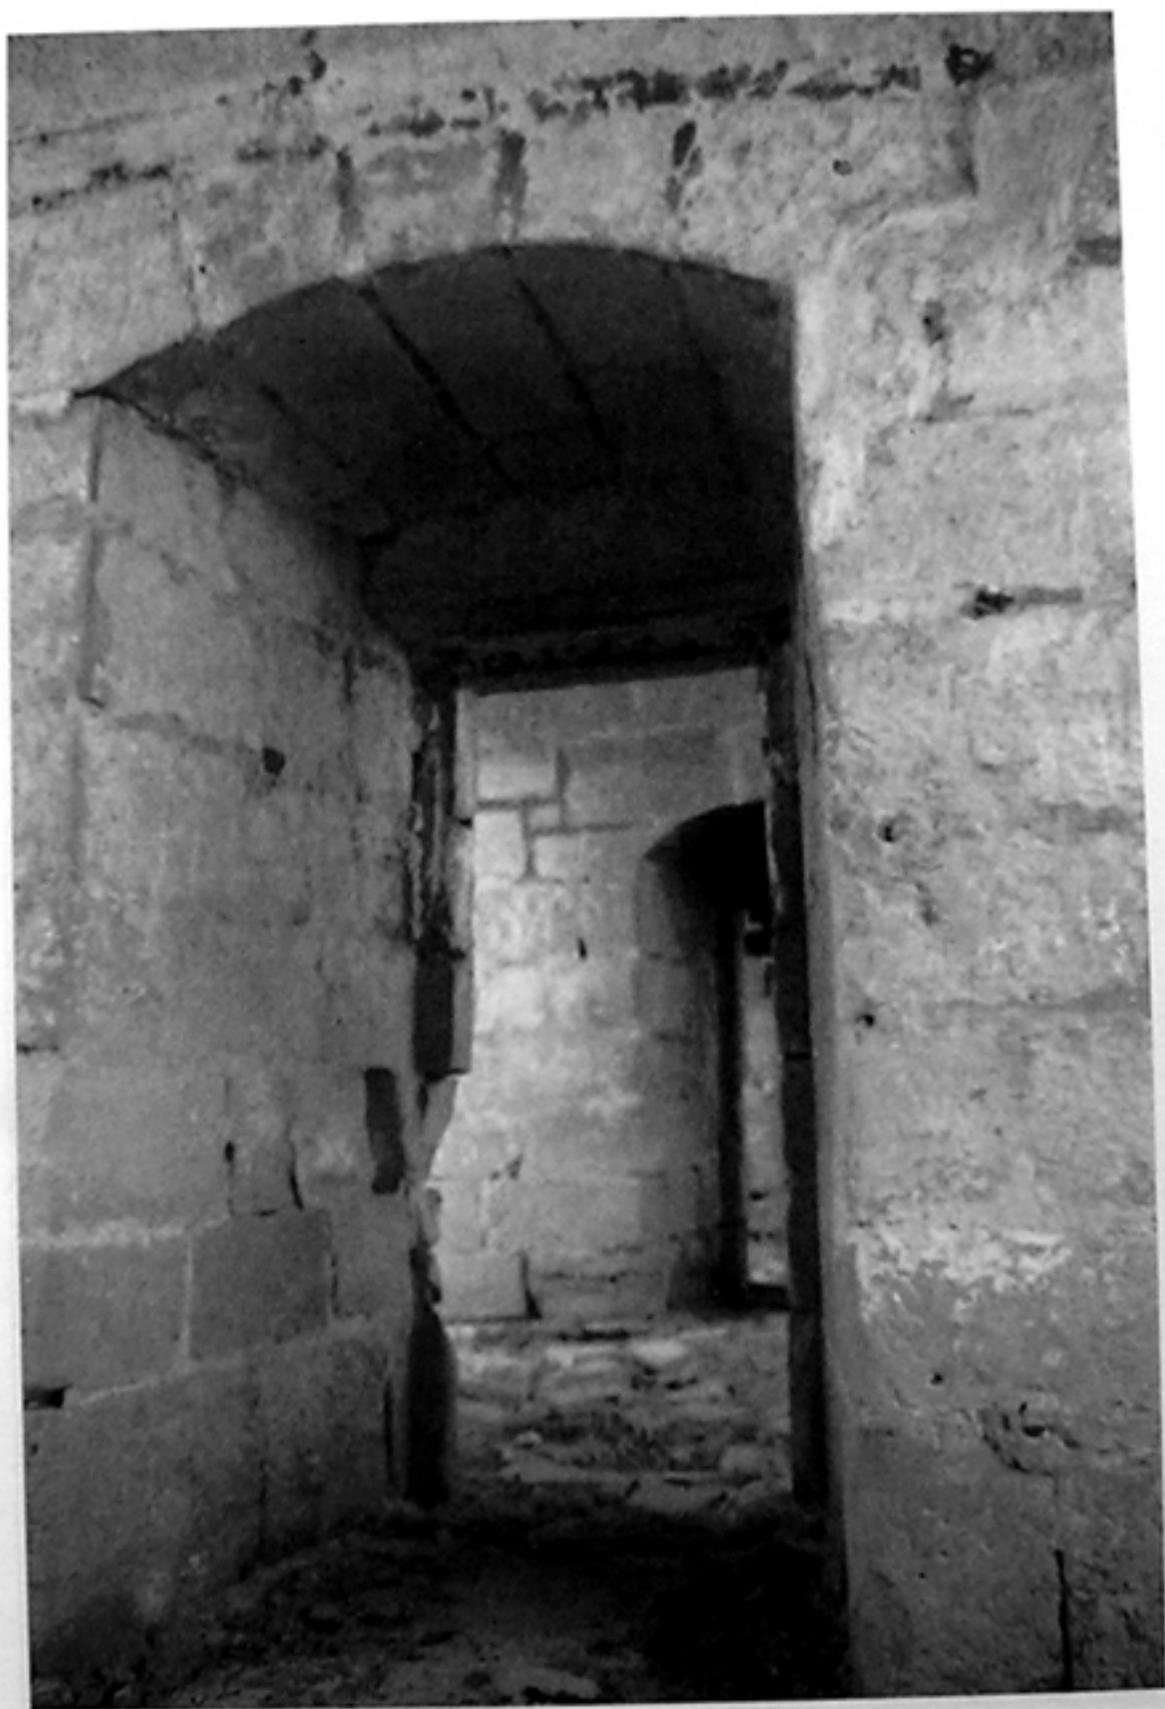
Puente de Mazuecos. Detalle de las galerías de arcos bajo el paso hacia Baeza.
